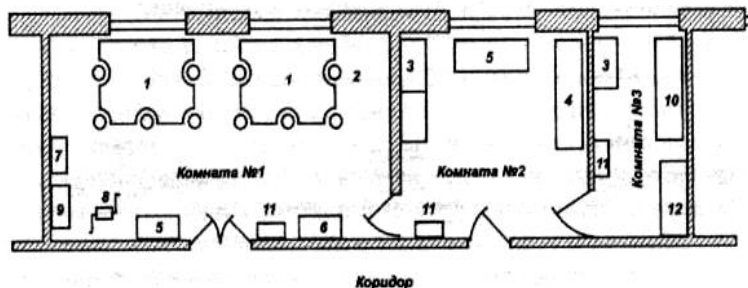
Схема размещения производственных помещений зуботехнической лаборатории: 1-рабочий стол, 2-стул, 3-вытяжной шкаф, 4-гипсовочная, 5-стол для формовки, 6-шкаф, 7-аппараты для протягивания гильз, 8-вальцы, 9-пресс, 10-полировочная установка, 11-раковина, 12-ящик для гипса.
